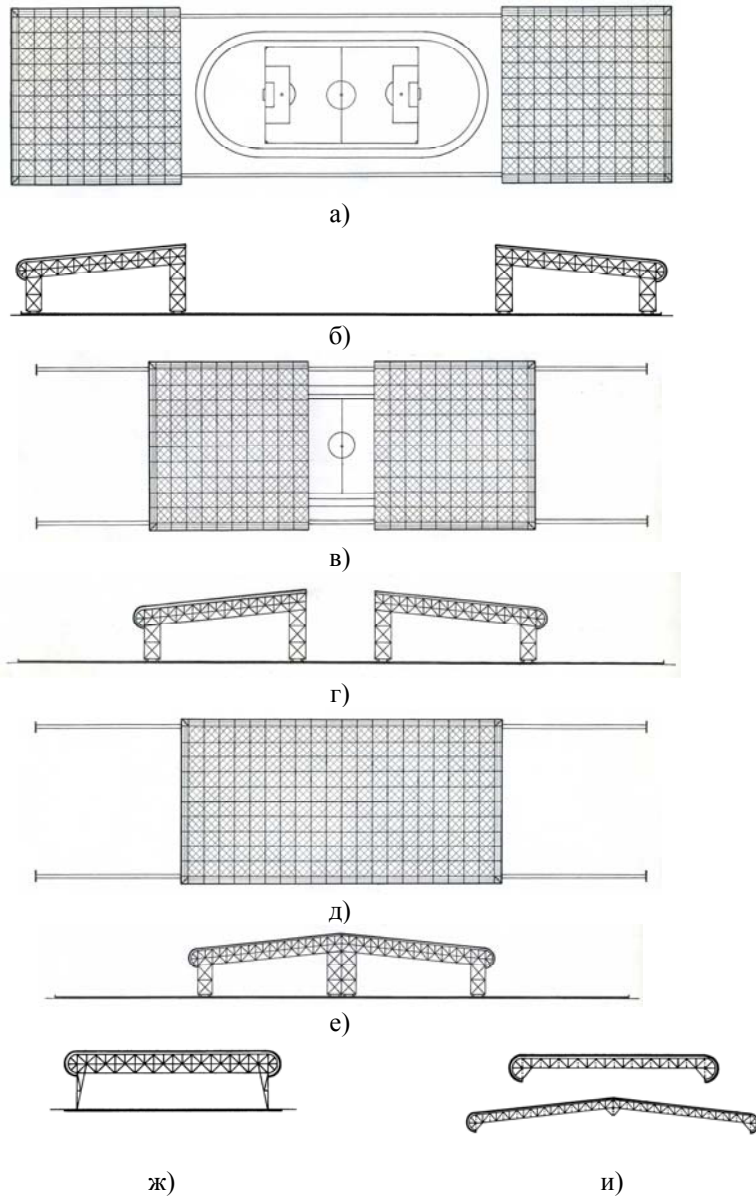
Схемы конструкций трансформируемого пространственного покрытия из двойных систем перекрестных ферм и балок:
